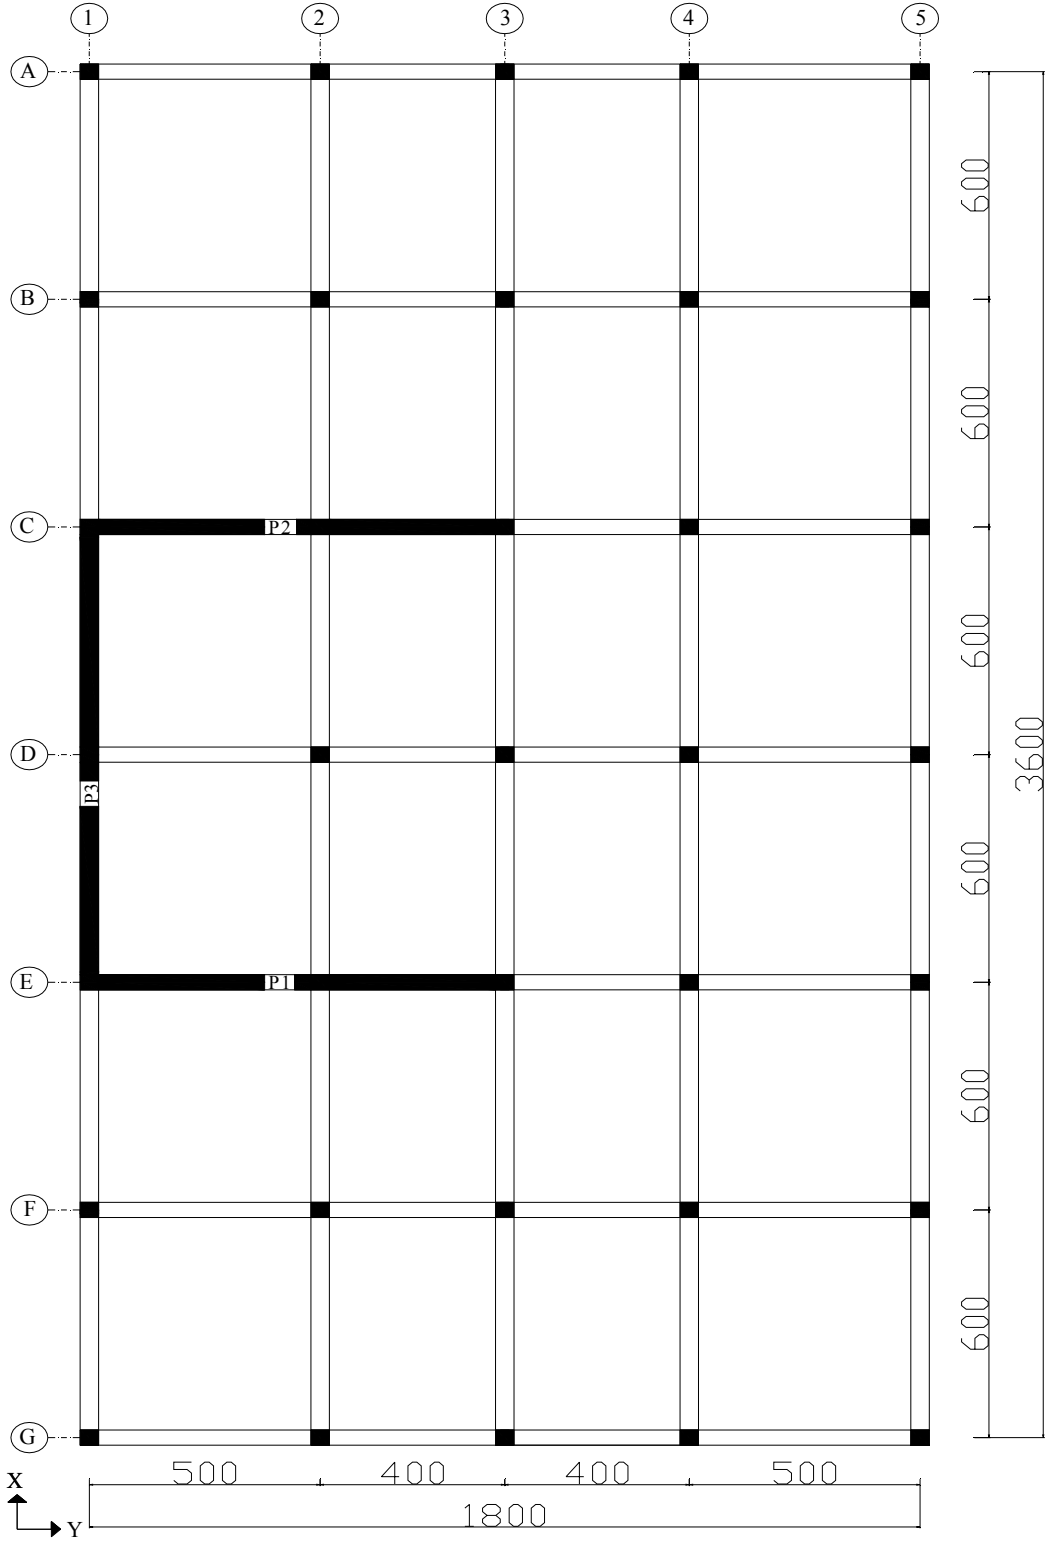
Örnek 5.15'in kat kalıp planı
